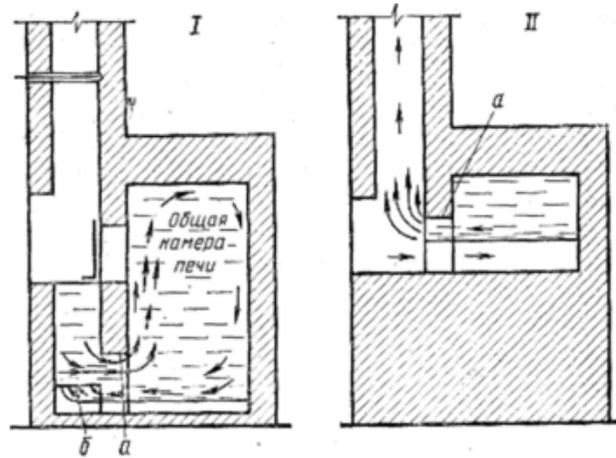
Схемы движения дымовых газов для обогрева общей камеры печи «Теплушка-5» (I) и при топке обычной русской печи (II): а, б — подвёртки
